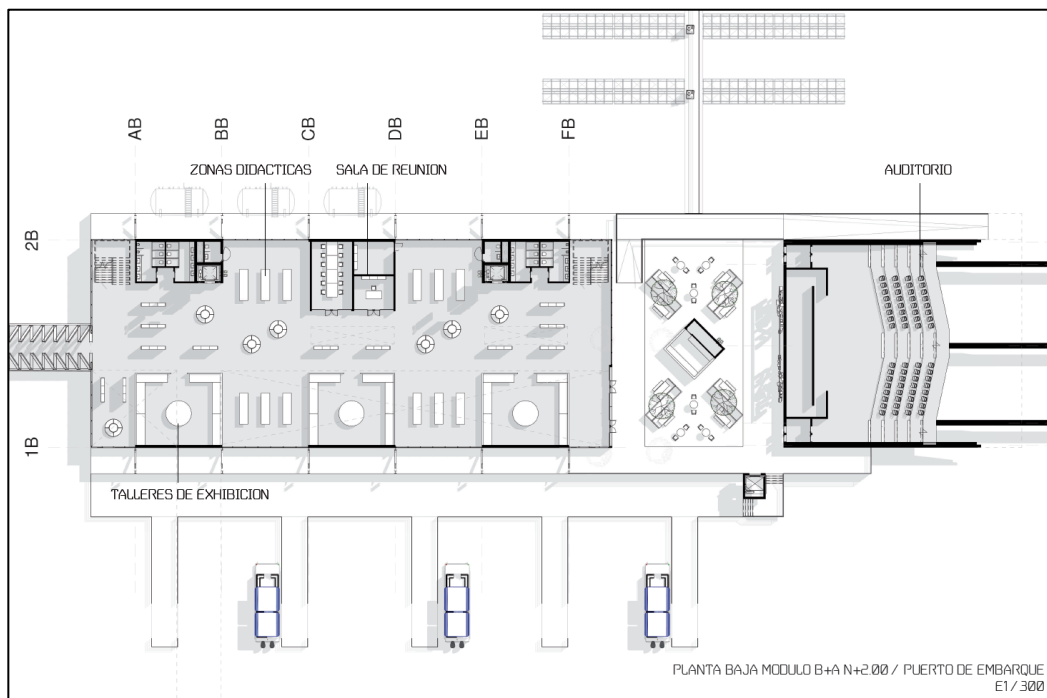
Planta N+2.00 Módulo B+A. Elaboración propia.
